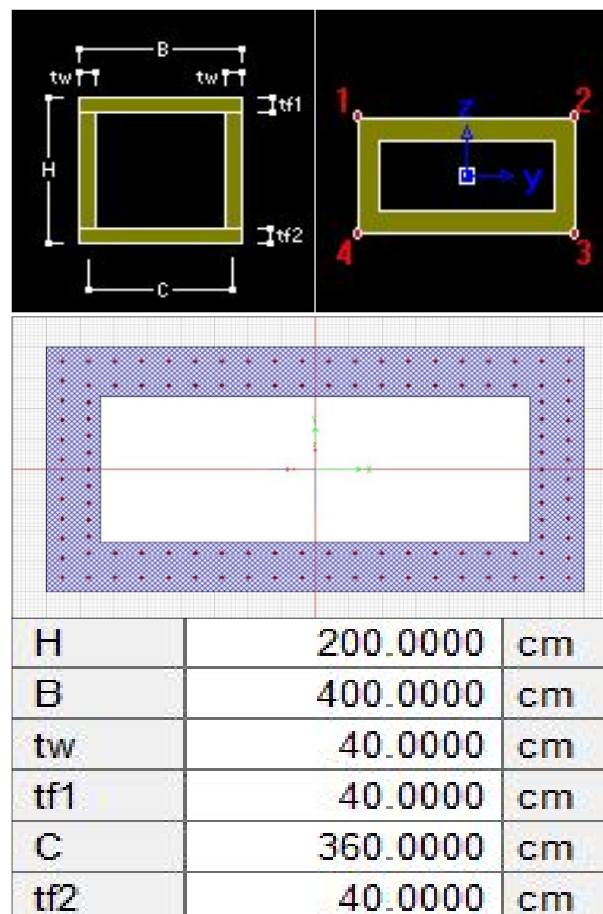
Sección y refuerzo longitudinal en pila central.
